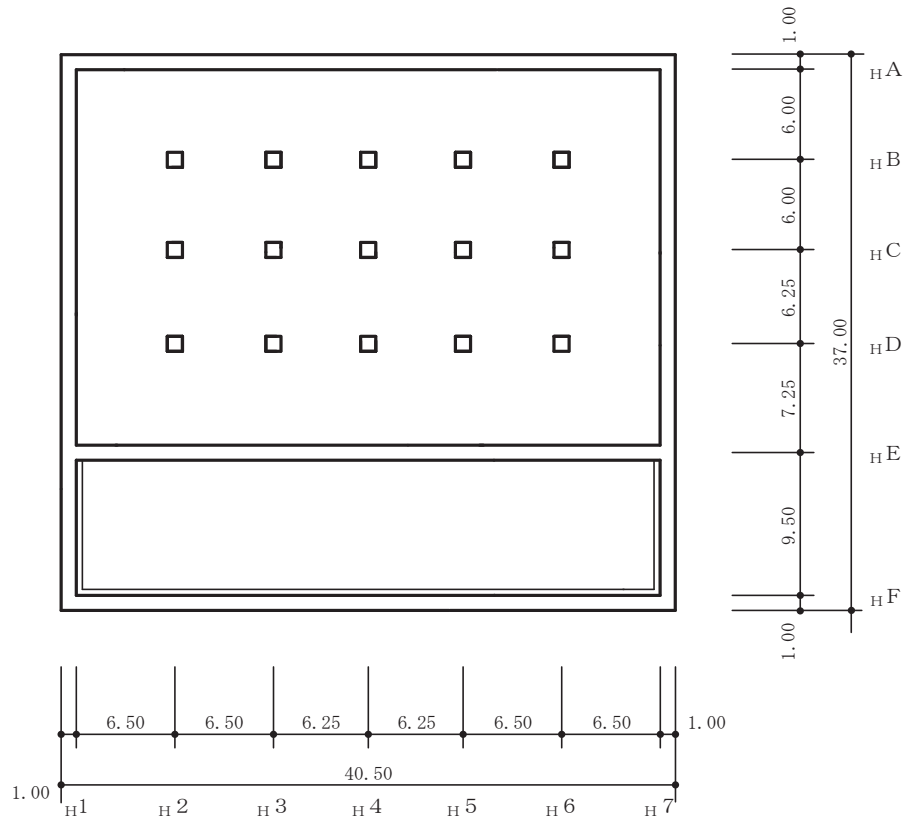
(1) 第 3 号機海水熱交換器建屋の概略平面図 (0.P.\*-9.5m)
